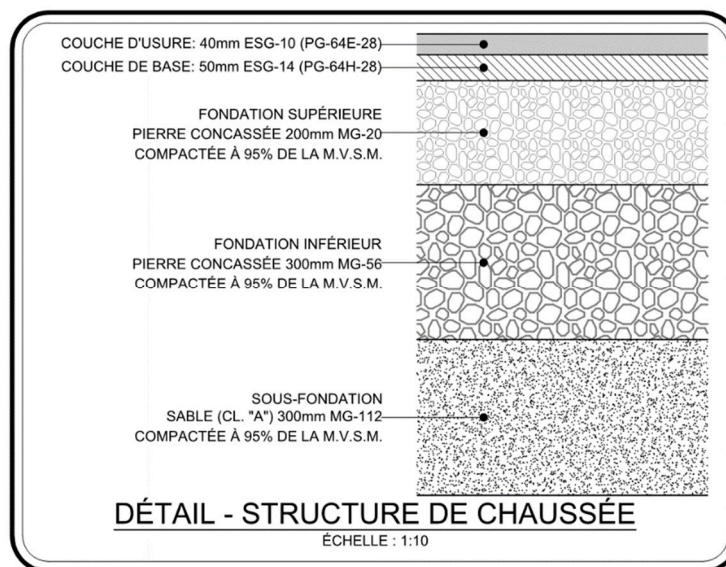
a: Structure de la chaussée (bloc : CHA-StructureChaussee.dwg)
